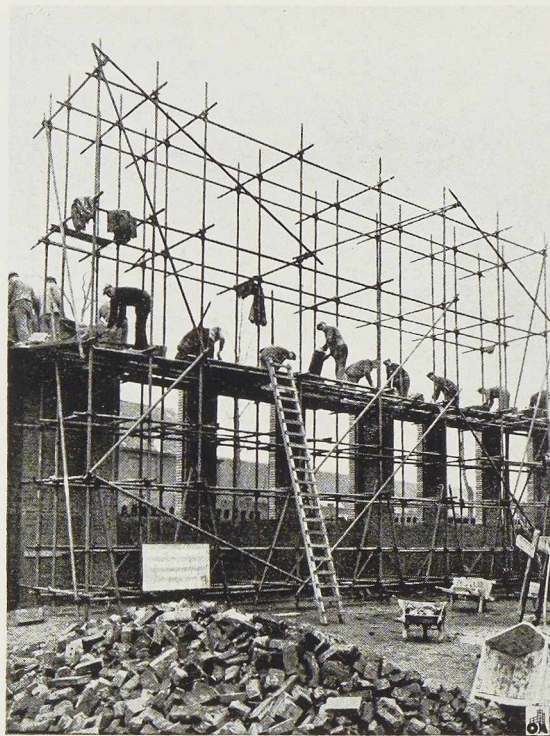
Construction d'une façade d'atelier à l'aide d'un échafaudage en tubes d'acier.
